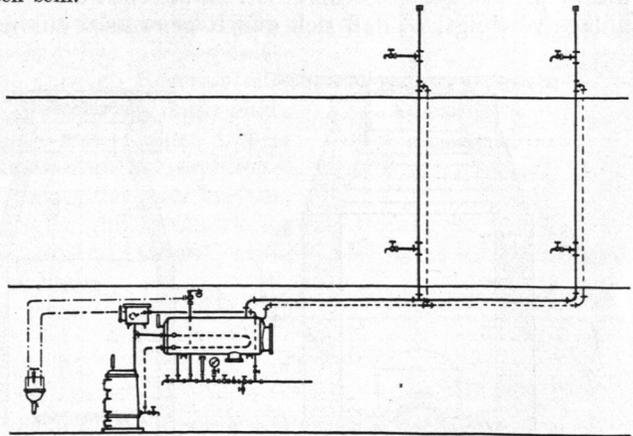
Schaltungsschema einer Warmwasserbereitung nach dem Hochdrucksystem; die Anlage steht unter dem Druck der Wasserleitung.
